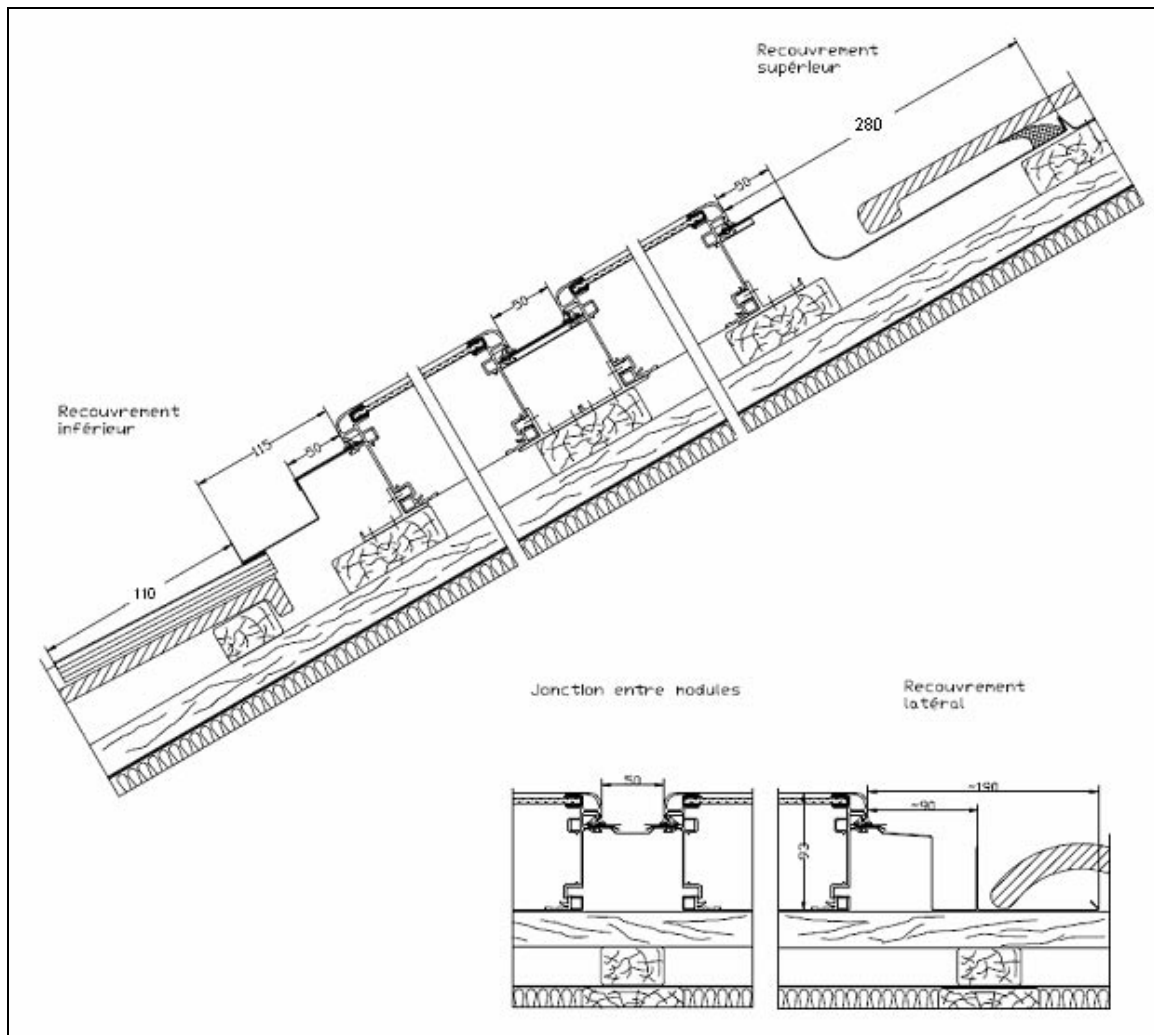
Vues d'ensemble en coupe du panneau photovoltaïque "PREMIUM S3xx-PM $\gamma$ " pour couvertures en tuiles
